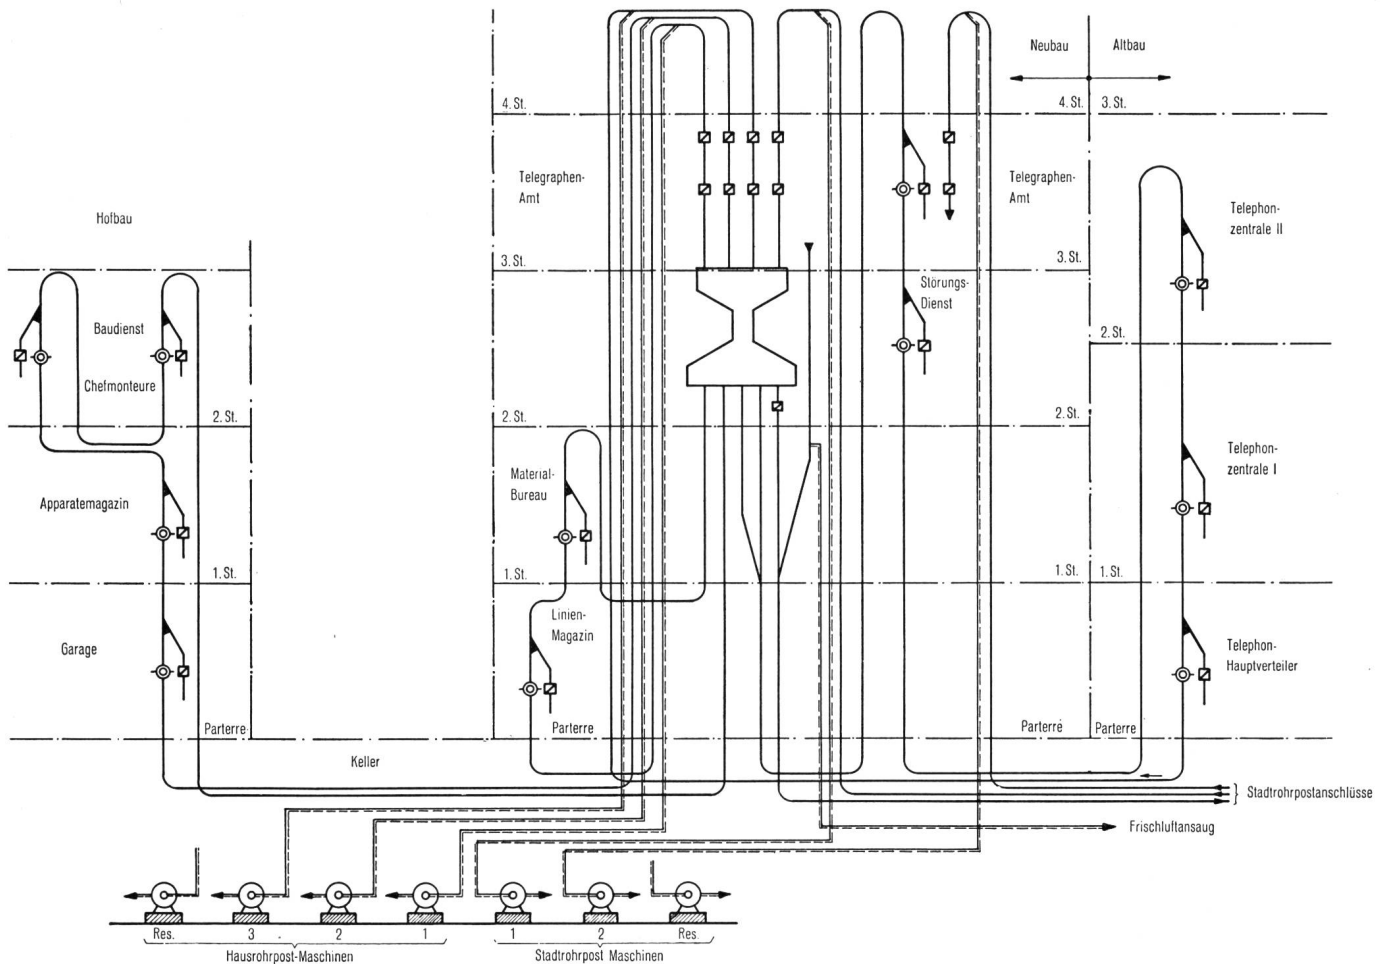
Prinzipschema der automatischen Hausrohrpostanlage im TT-Betriebsgebäude Basel-Zwingerstrasse mit drei Linien nach dem Kreislaufsystem und Stadtröhropstanschluss
